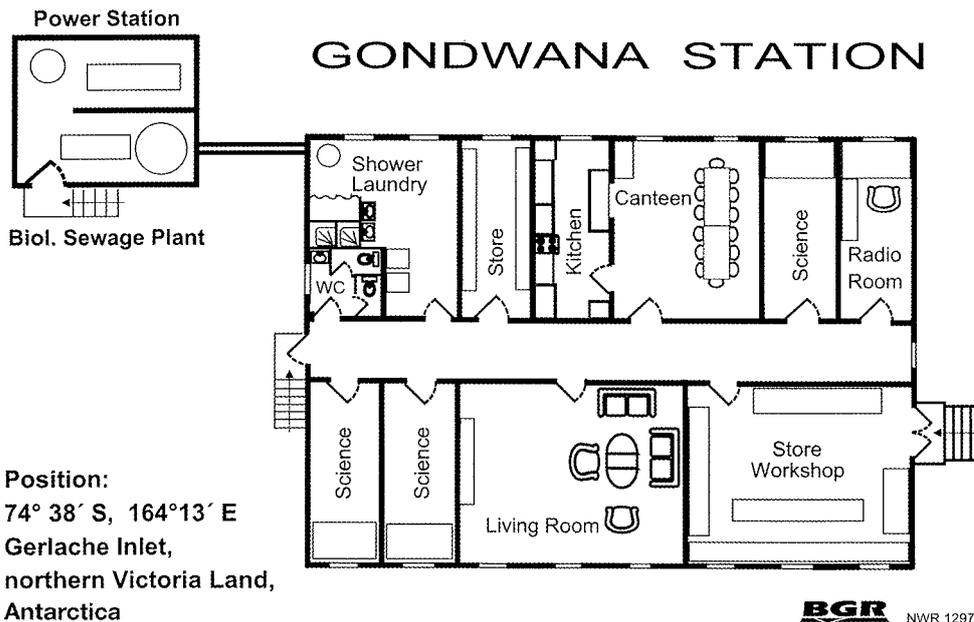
Grundriss und Nutzungsplan der Gondwana-Station.
